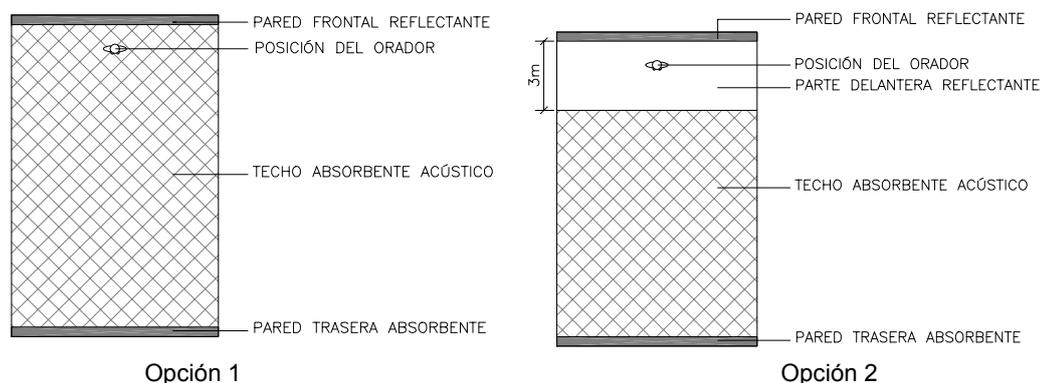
Vista en planta de las opciones 1 y 2
